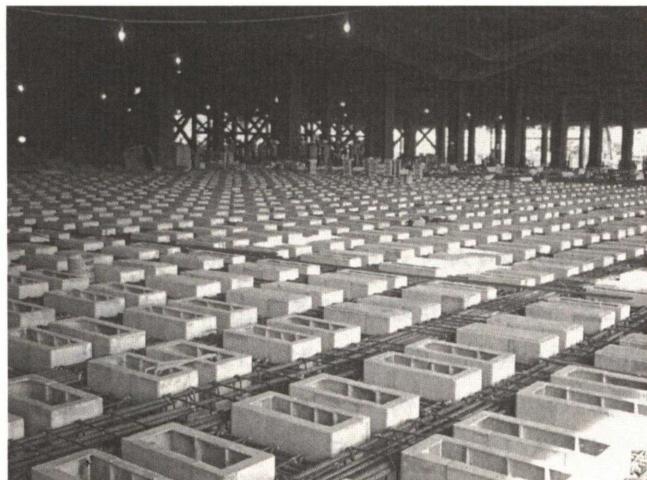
FAB 棟格子梁 FRP 型枠取付状況
